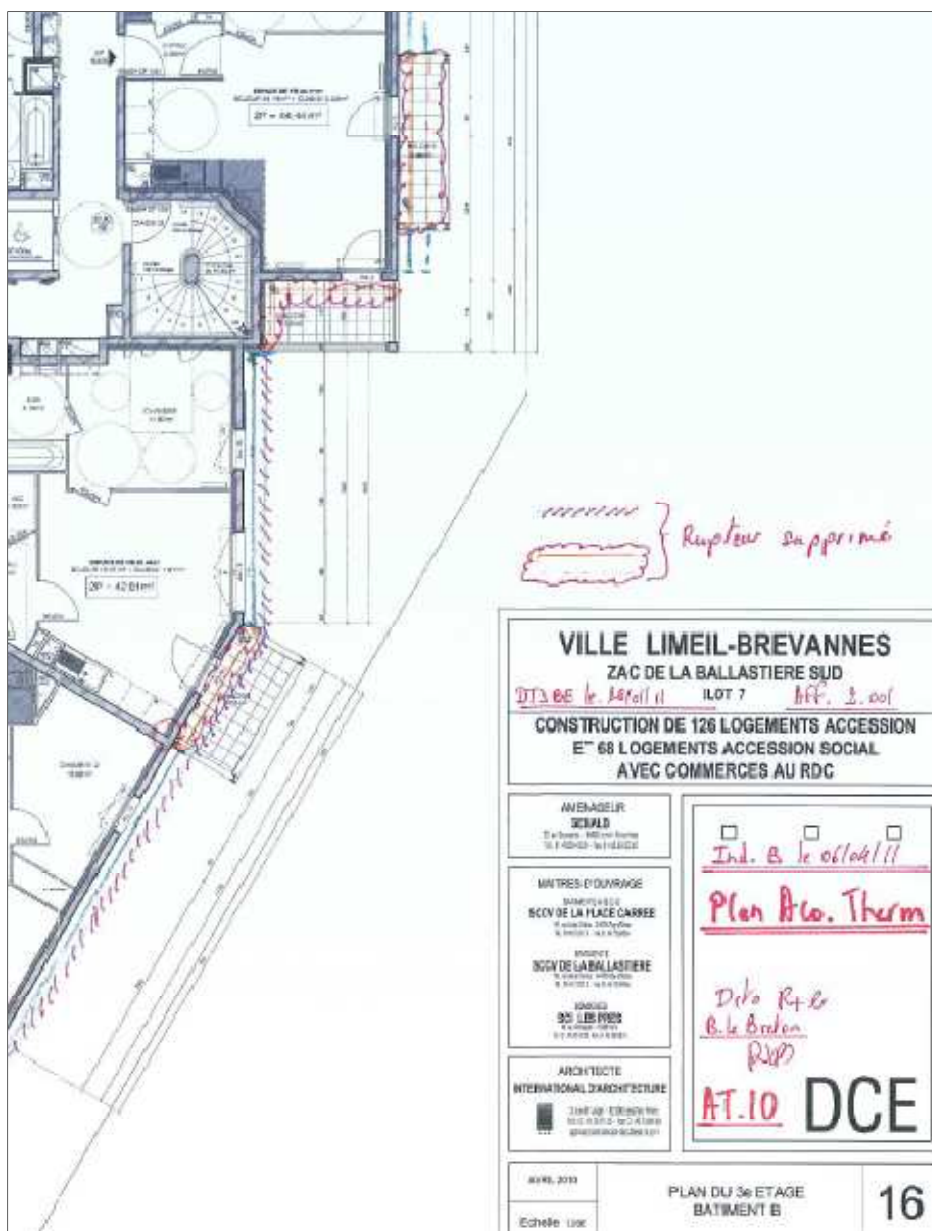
Plano acústico y térmico de la oficina técnica para la tercera planta del edificio B
